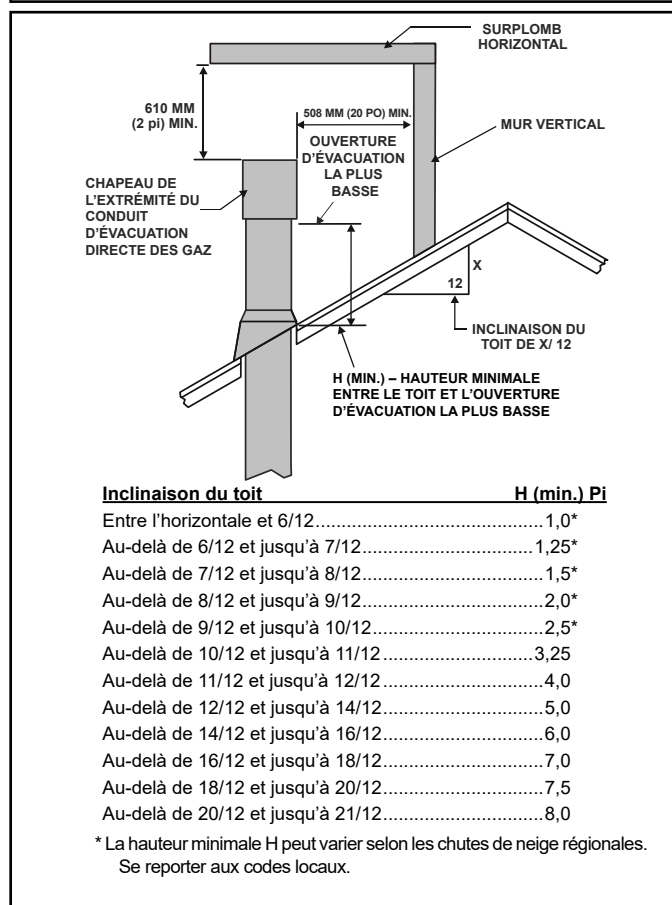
Hauteur minimale entre le toit et l'ouverture d'évacuation la plus basse
